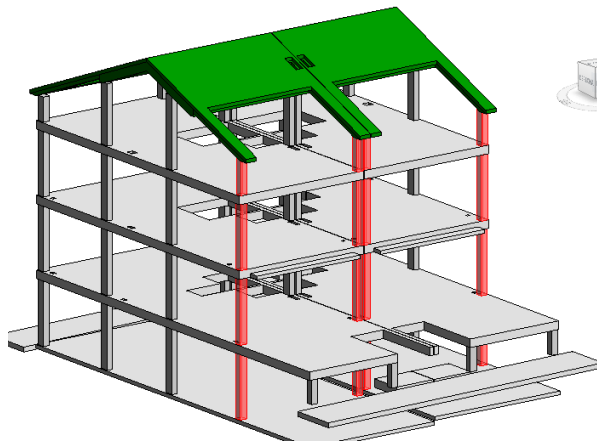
Incongruencia entre plano de arquitectura y plano cimentación/cuadro de pilares. 2014. Elaboración propia
